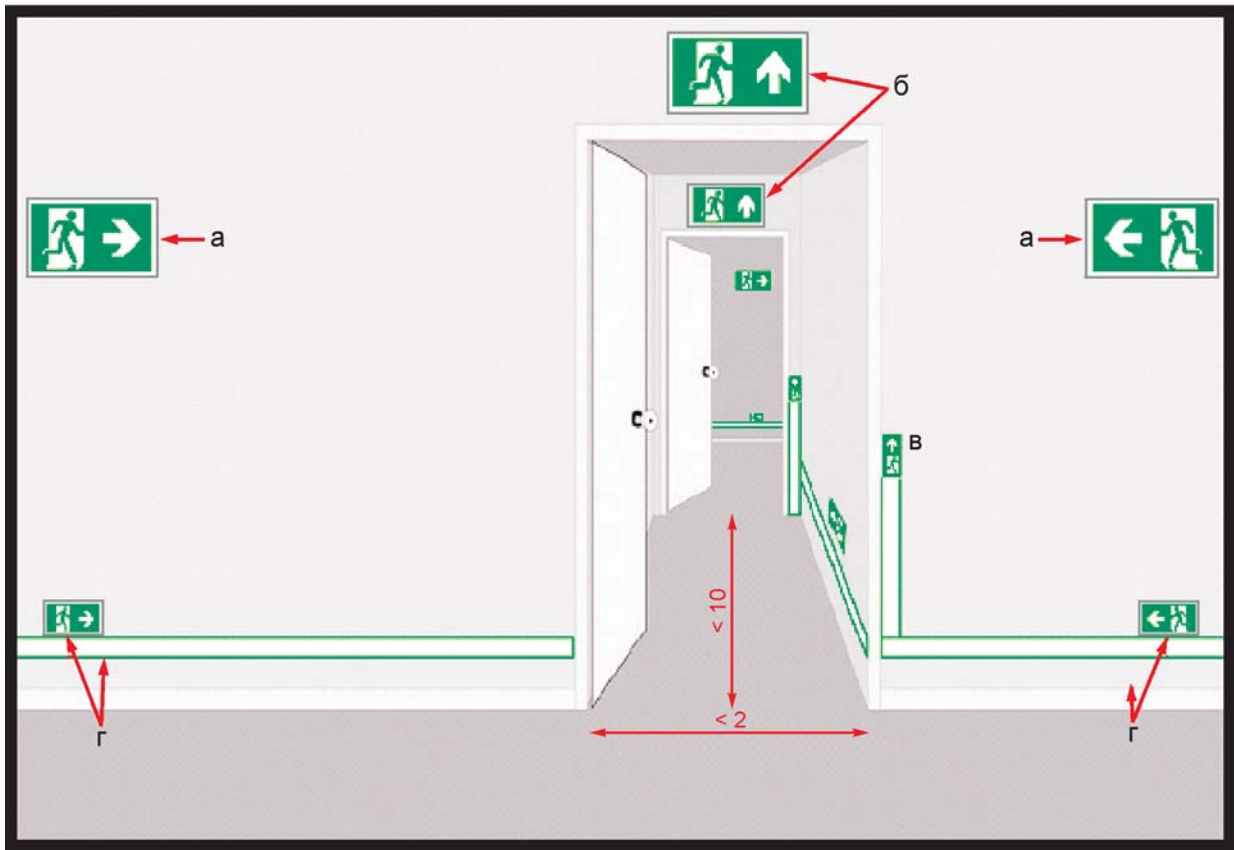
Примерный план Т-образного перекрестка, ведущего в прямой коридор (с более чем одной дверью), показывающий непрерывность обозначения
